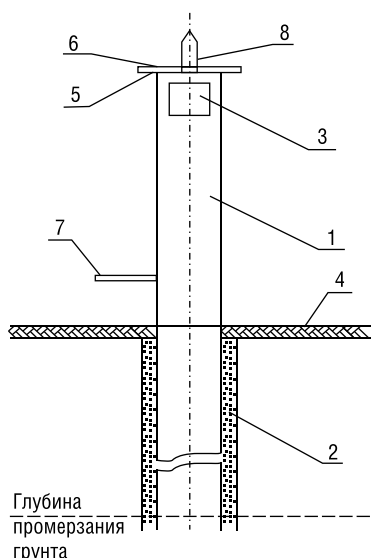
Конструкция и внешний вид пункта, обеспечивающего принудительное центрирование спутниковых приборов.
